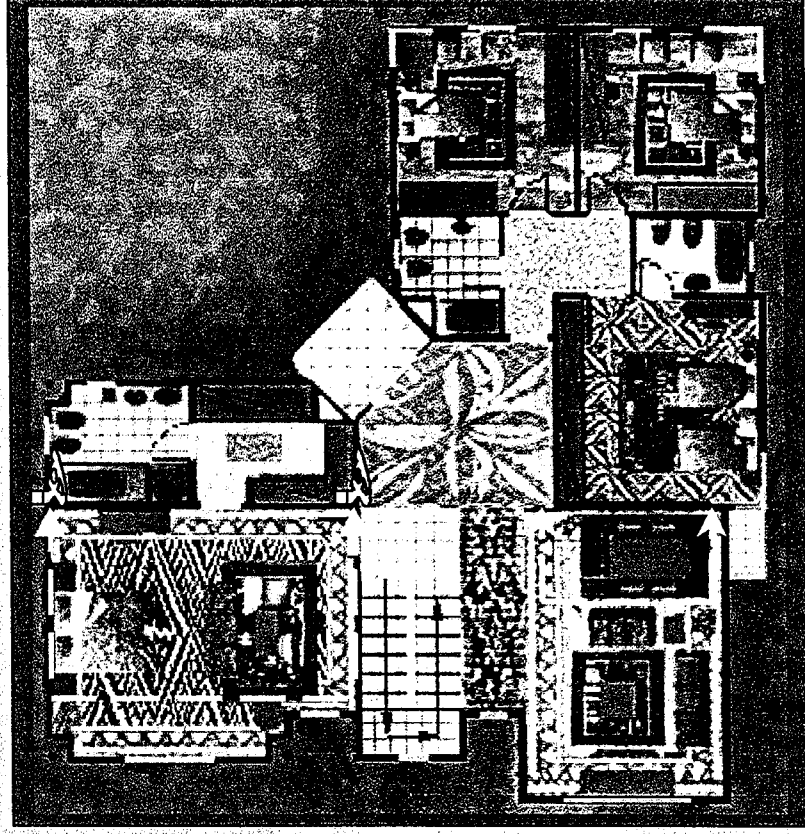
مسقط أفقي للدور الأول يوضح توزيع الأثاث عليه (نموذج رقم ١)
